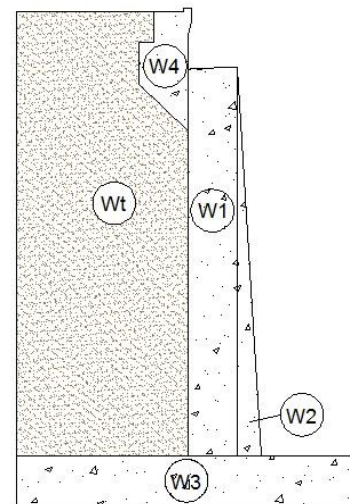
Figura XVII: SECCIÓN PROPUESTA PARA EL ESTRIBO
